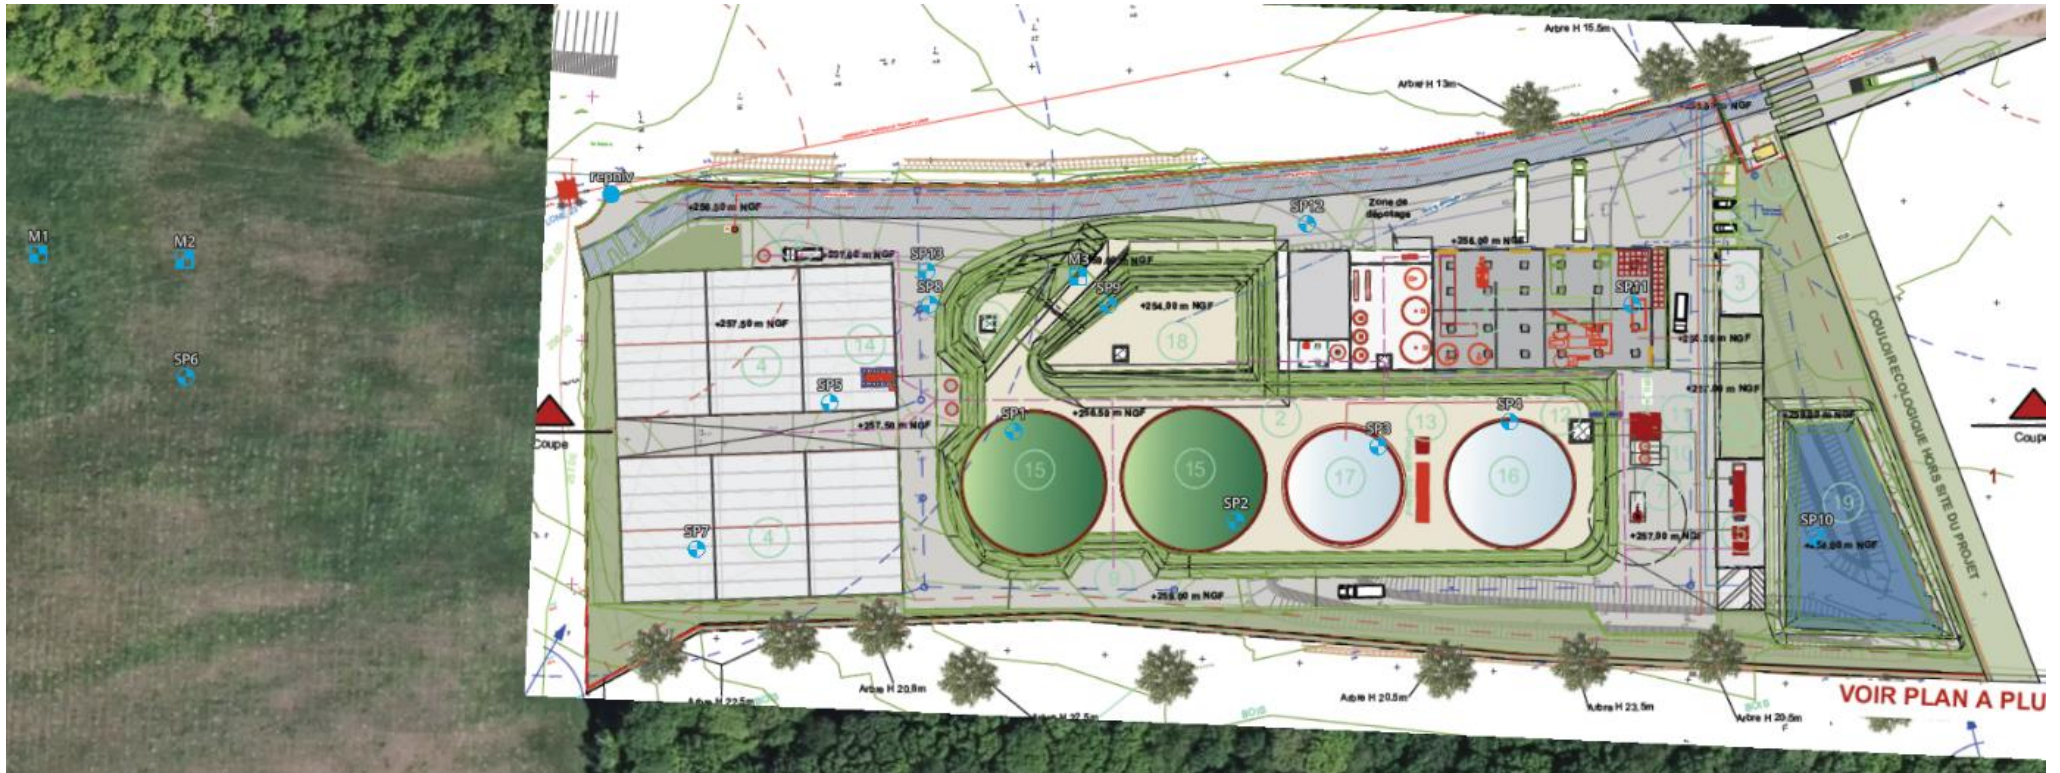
Plan d'implantation des sondages Fondasol (08/2020)
